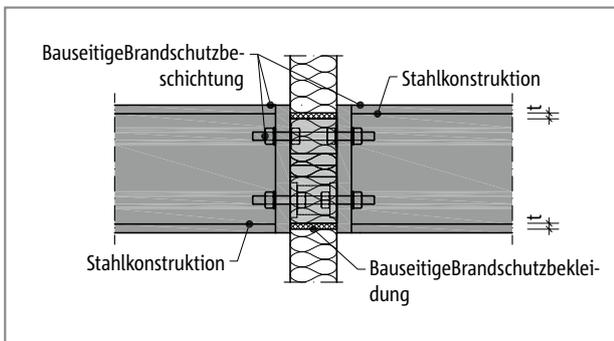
Brandschutz Schöck Isokorb® T Typ S: Bauseitige Brandschutzbekleidung T Typ S, brandschutzbeschichtete Stahlkonstruktion; Schnitt
